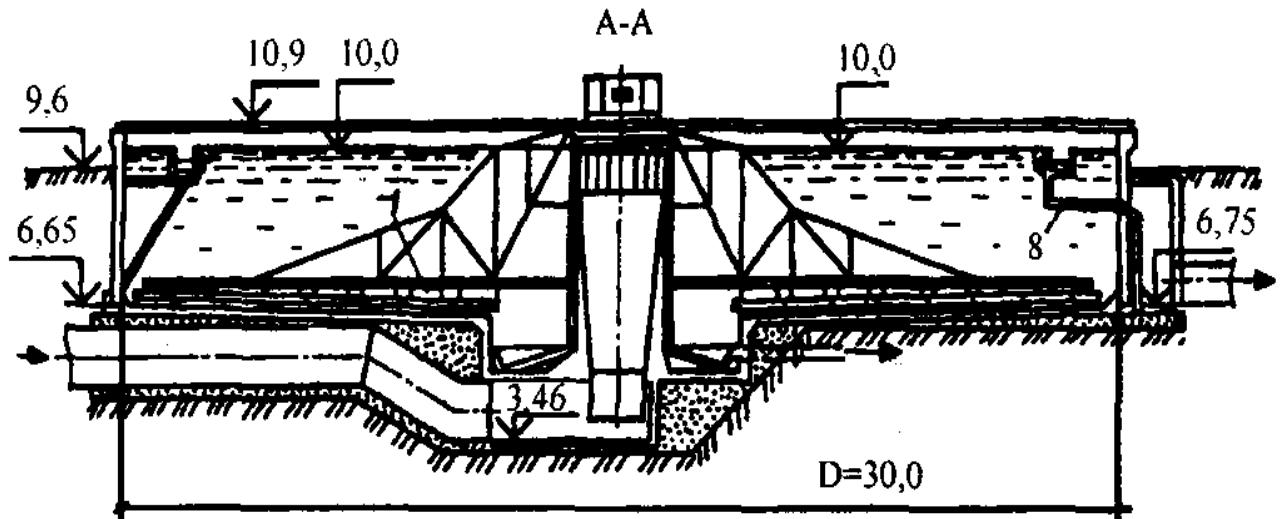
Первичные радиальные отстойники: 1 - илоскреб; 2 - распределительная камера; 3 - подводящий трубопровод; 4 - трубопровод выгрузки осадка; 5 - жиросборник; 6 - насосная станция перекачки осадка; 7 - трубопровод отвода осветленной воды; 8 - жиропровод
